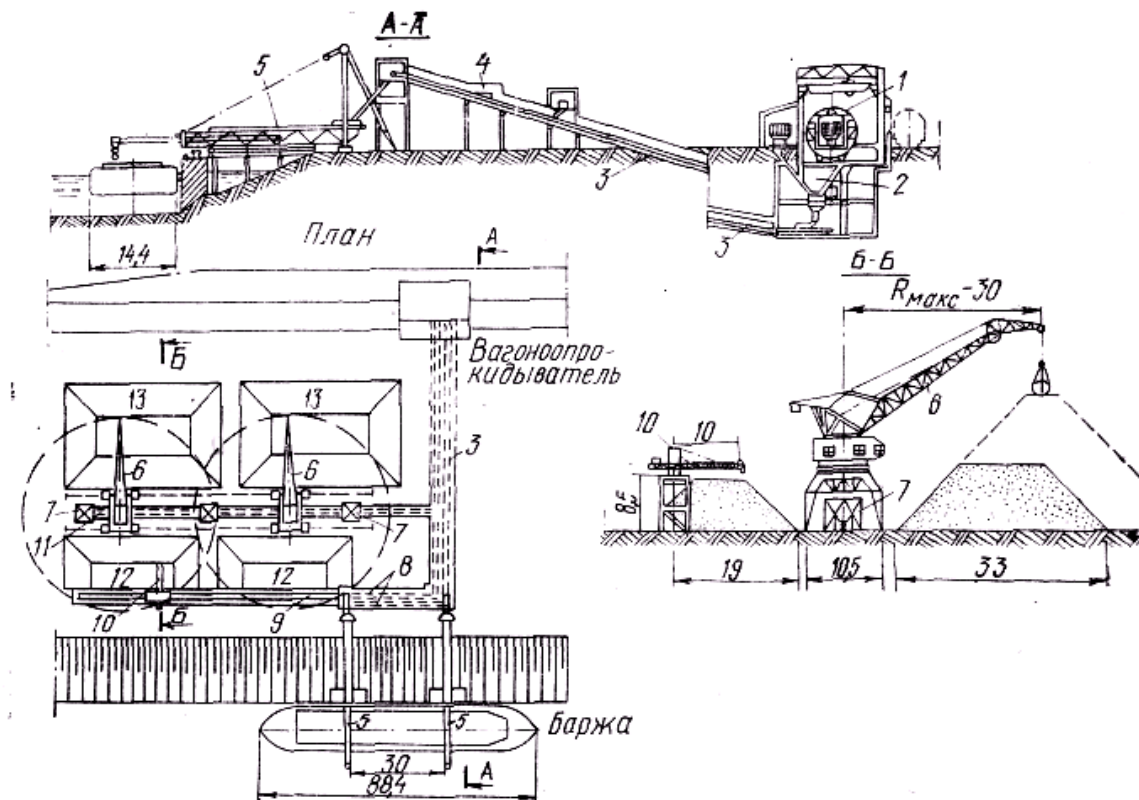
Схема перевалки угля с использованием роторного вагонопрокидывателя
